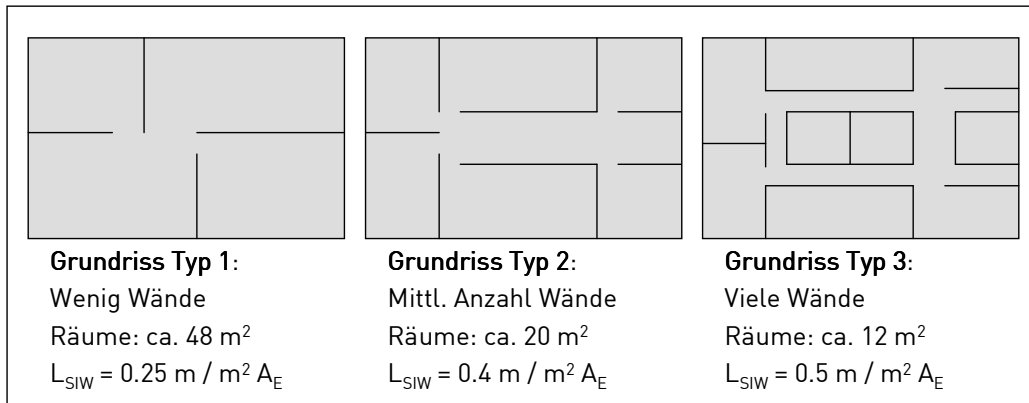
Die verschiedenen Grundrisstypen als Grundlage für das Mengengerüst der Innenwände.
